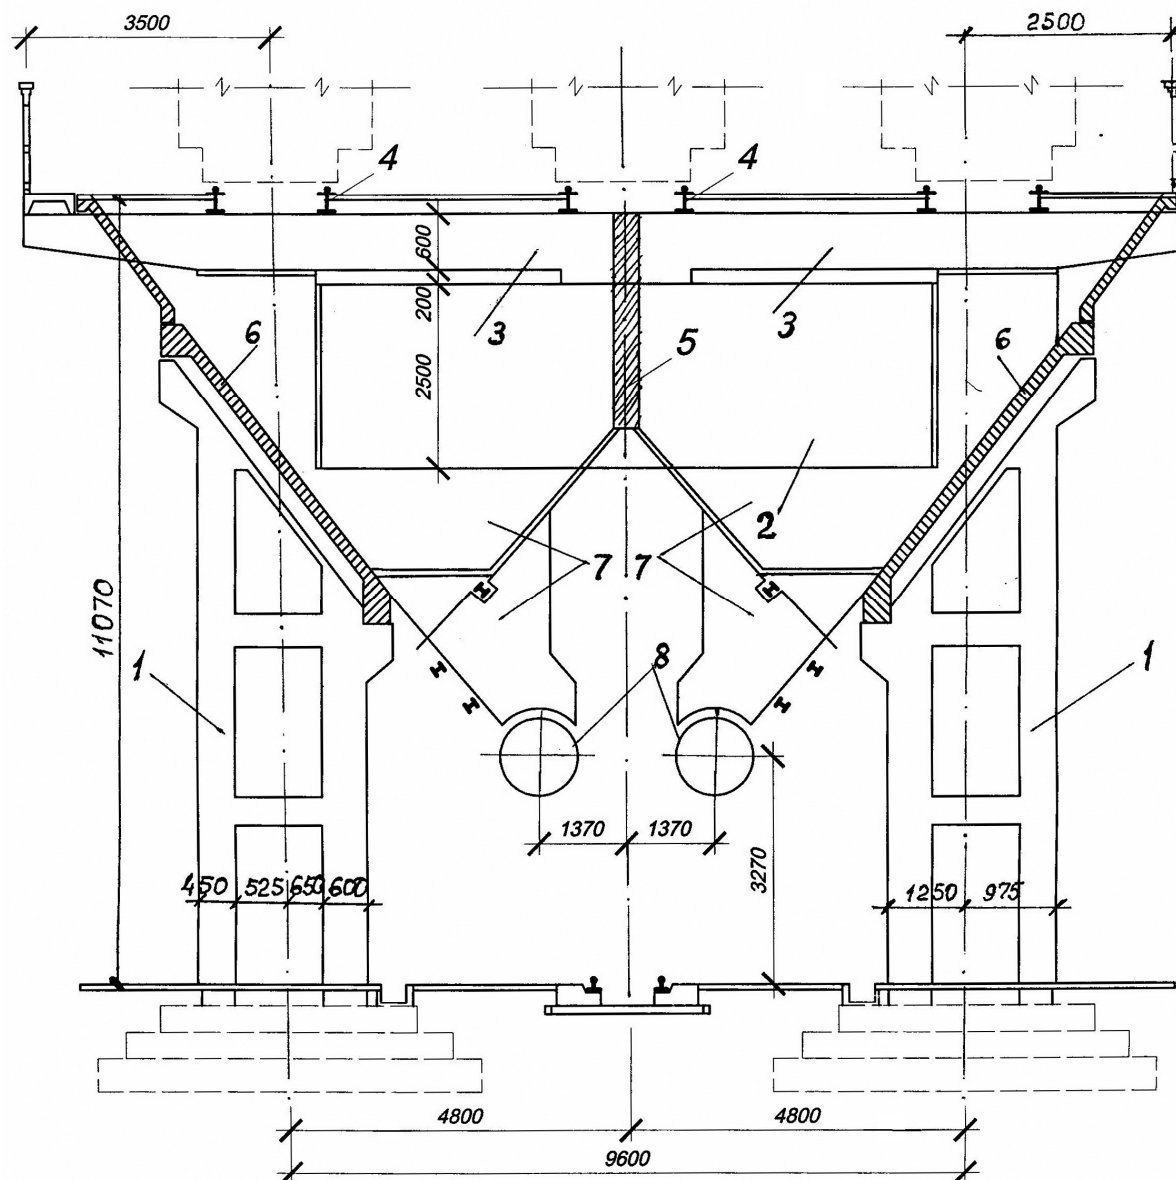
Поперечный разрез бункерной эстакады под руду Макеевского металлургического комбината: 1 – колонны; 2 – поперечная балка-ригель; 3 – консольные железобетонные балки; 4 – подпоездные балки; 5 – средняя продольная балка; 6 – сборная железобетонная панель бункера; 7 – металлические элементы бункера; 8 – затворы
